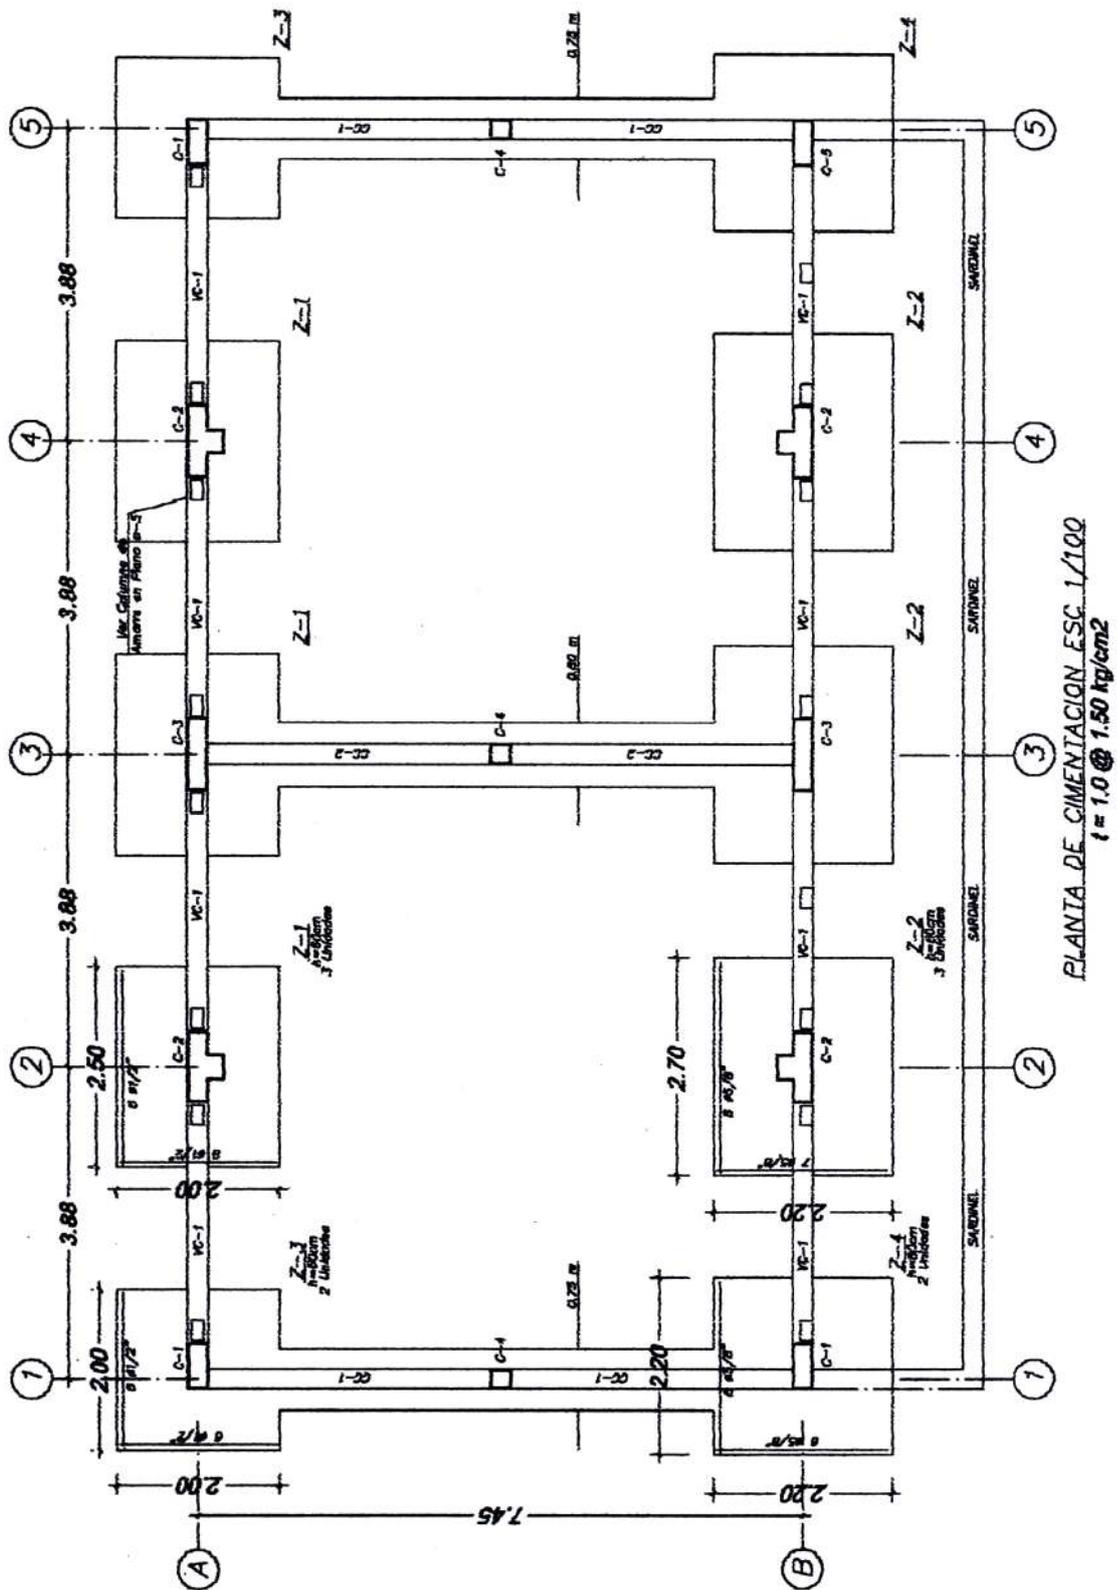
PLANTA DE CIMENTACION 2 AULAS-2 PISOS (CAPACIDAD PORTANTE TERRENO 1.0 – 1.50 Kg/cm²)
